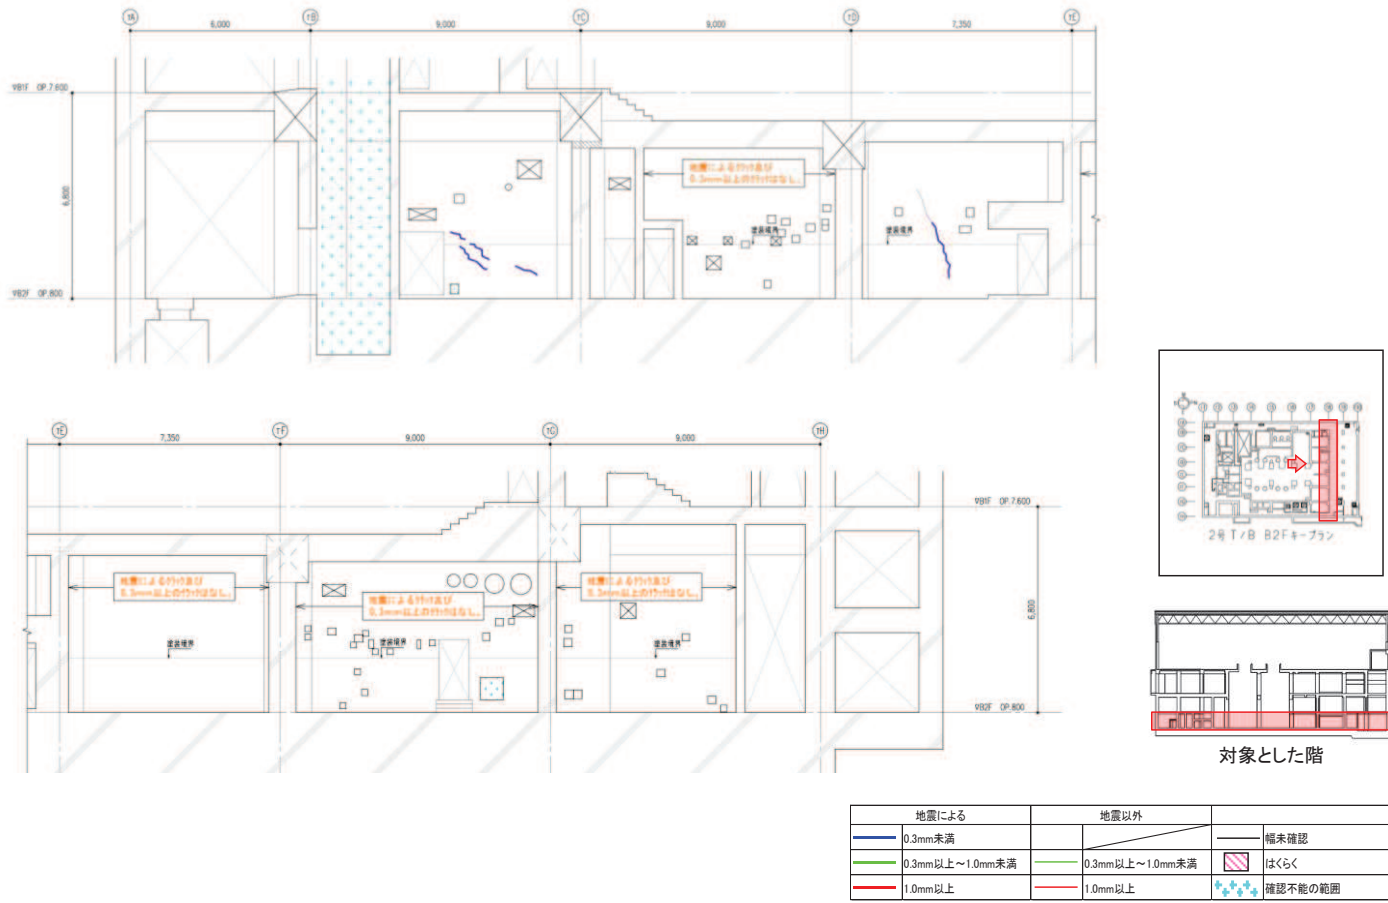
タービン建屋のひび割れ分布 耐震壁(8) 地下2階 T8通り
